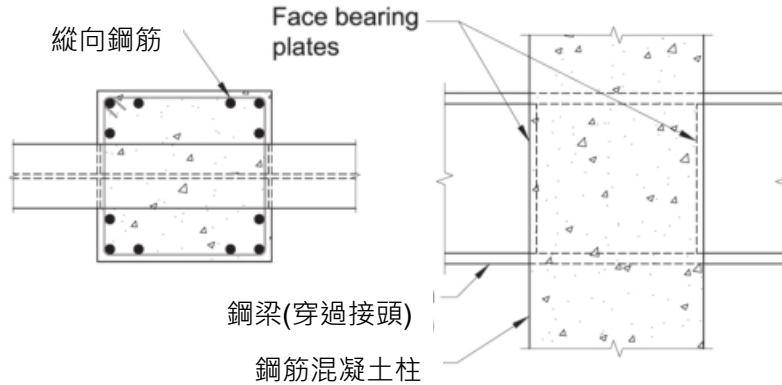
鋼筋混凝土柱與鋼梁之彎矩接合
